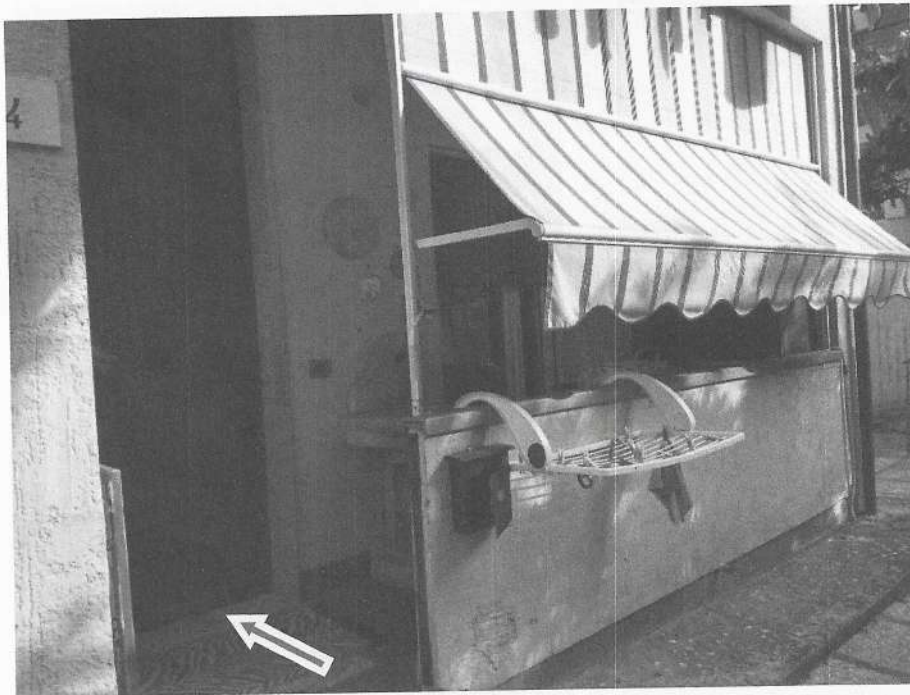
Vista della corte comune retrostante al piano terreno, del terrazzo e Dell'ingresso alla abitazione.
